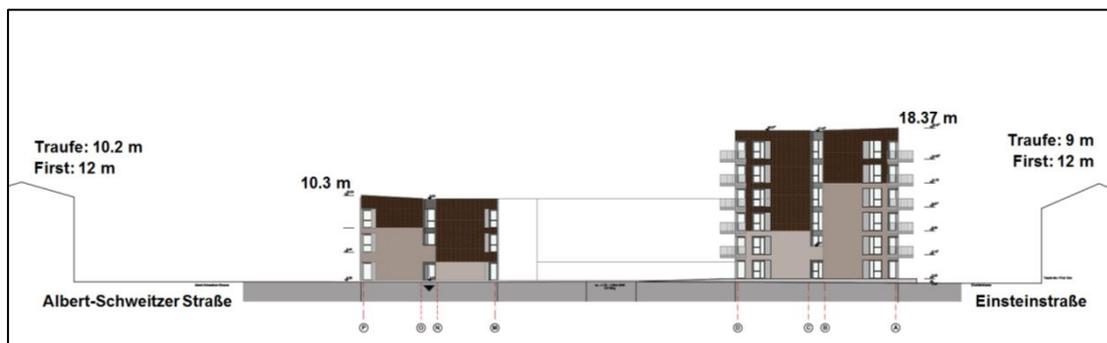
Süd-West Ansicht (Haslob Kruse + Partner Architekten, Bremen)
